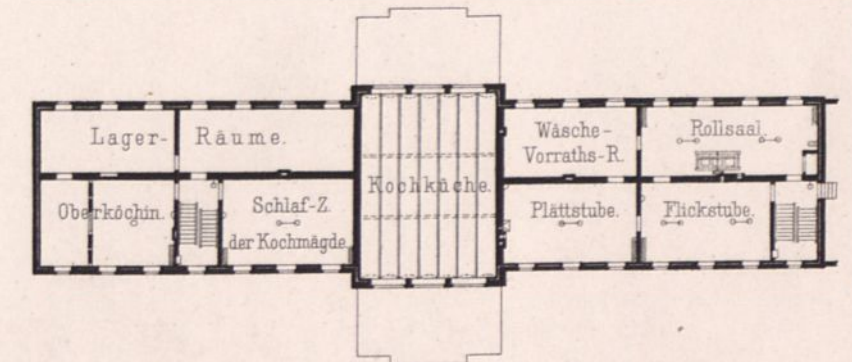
Betriebsgebäude. Theil des Grundrisses vom Obergeschoss.
